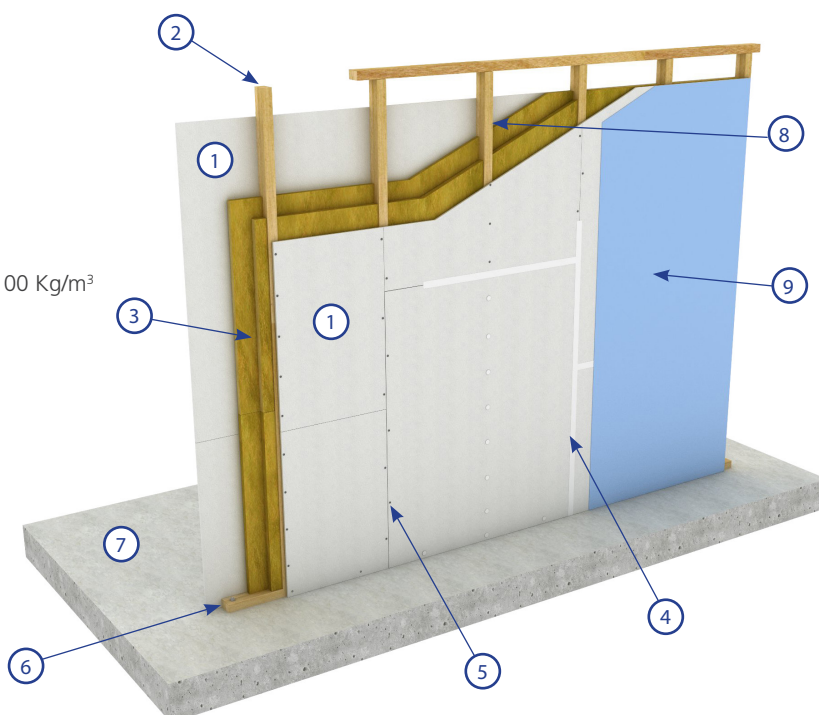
Tabiquería PassiveTec® - Listones de madera
